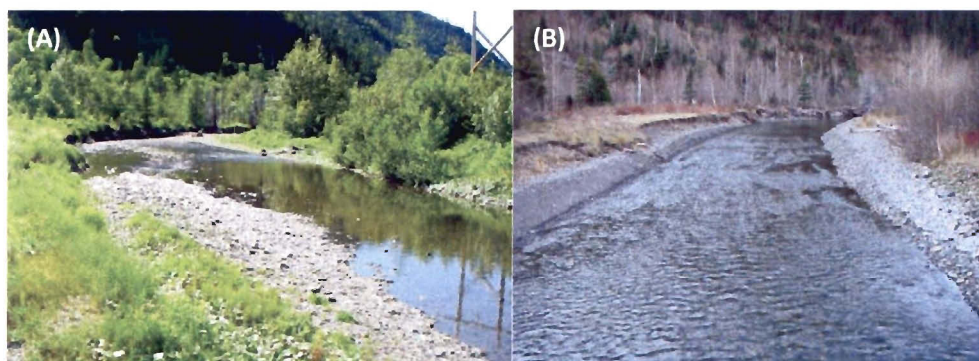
Photographie de la section aval du pont P02775 avant les travaux (A) et après les travaux (B).
